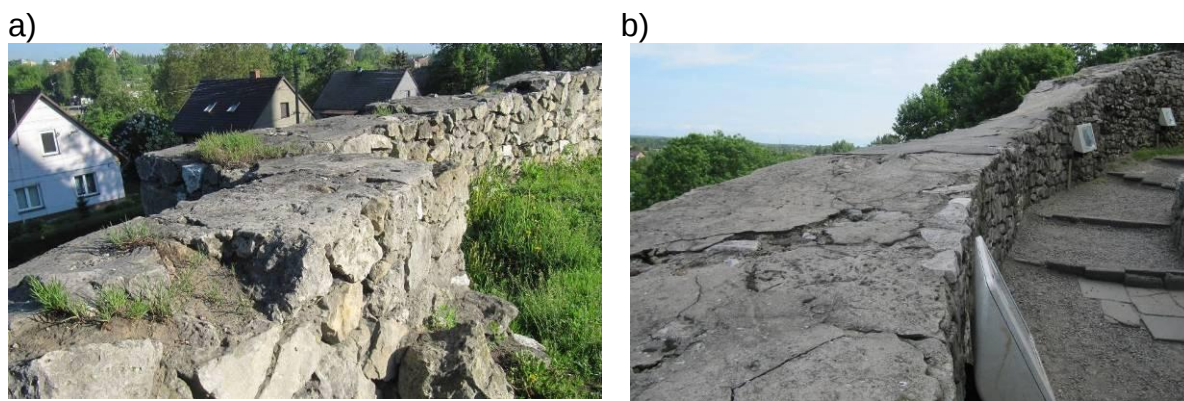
Przykładowe ubytki muru przypory zamku górnego
